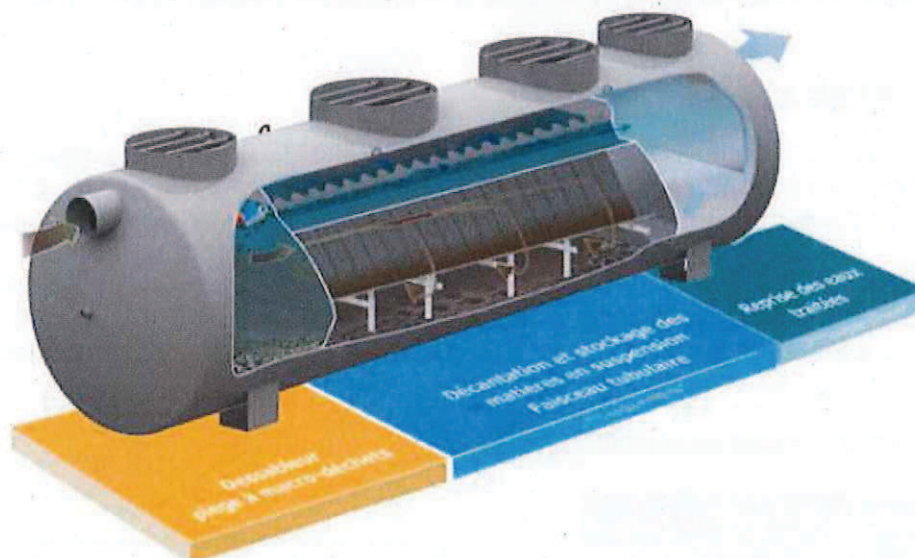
Schéma type d'un décanteur (source : Techneau, 2016)
